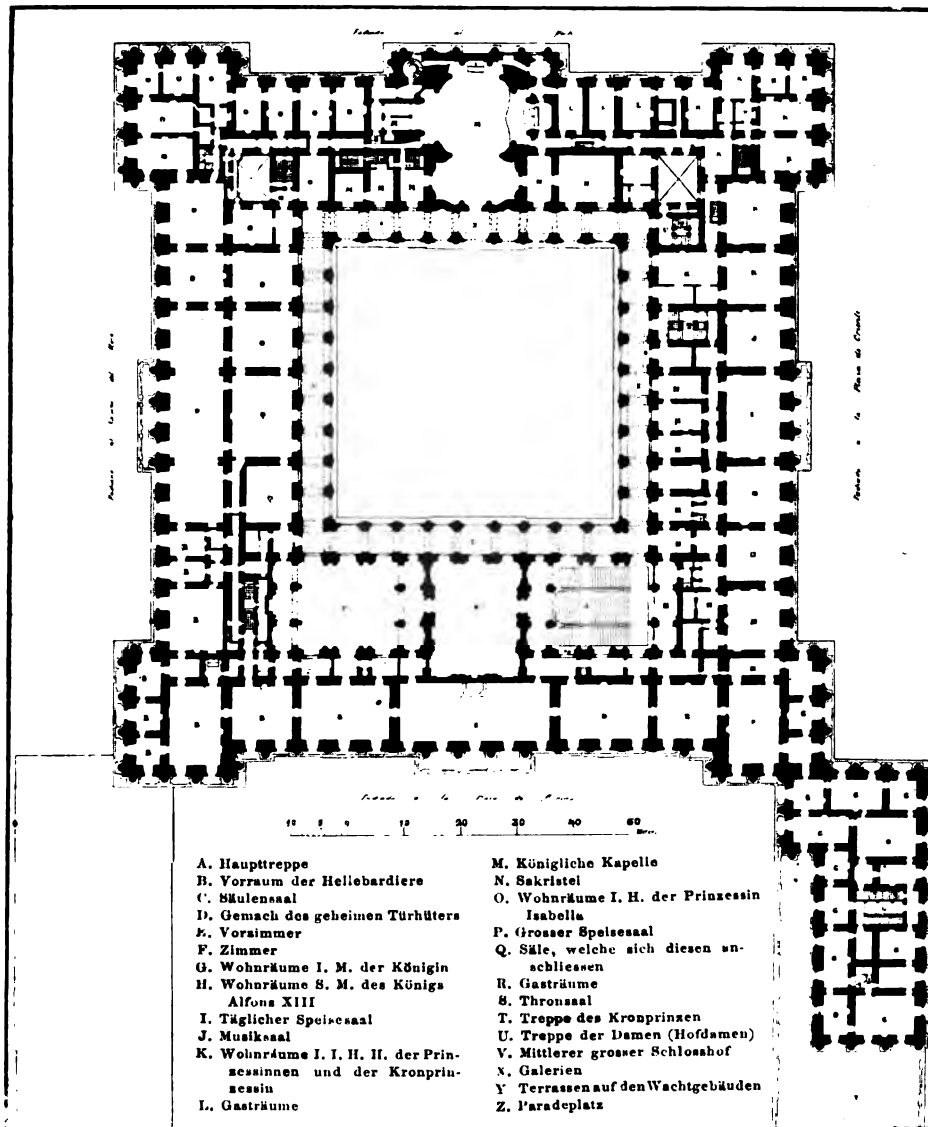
Kgl. Schloß in Madrid Grundriß (Nach Juan Bautista Saquetis Original)
